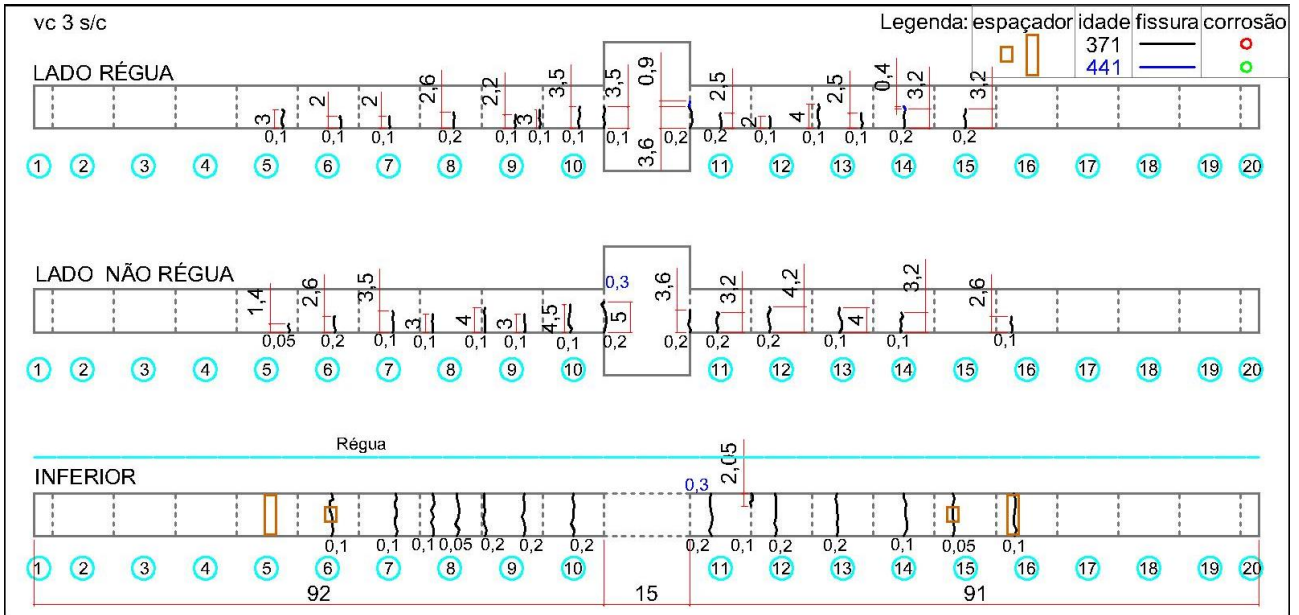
Mapa das fissuras na viga vc 3 s/c
